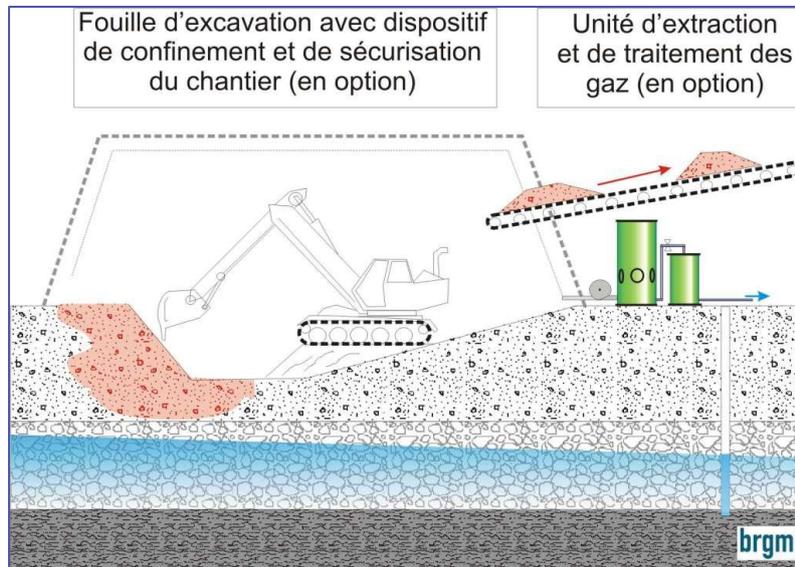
Schéma d'un traitement par excavation des sols (source : BRGM)
